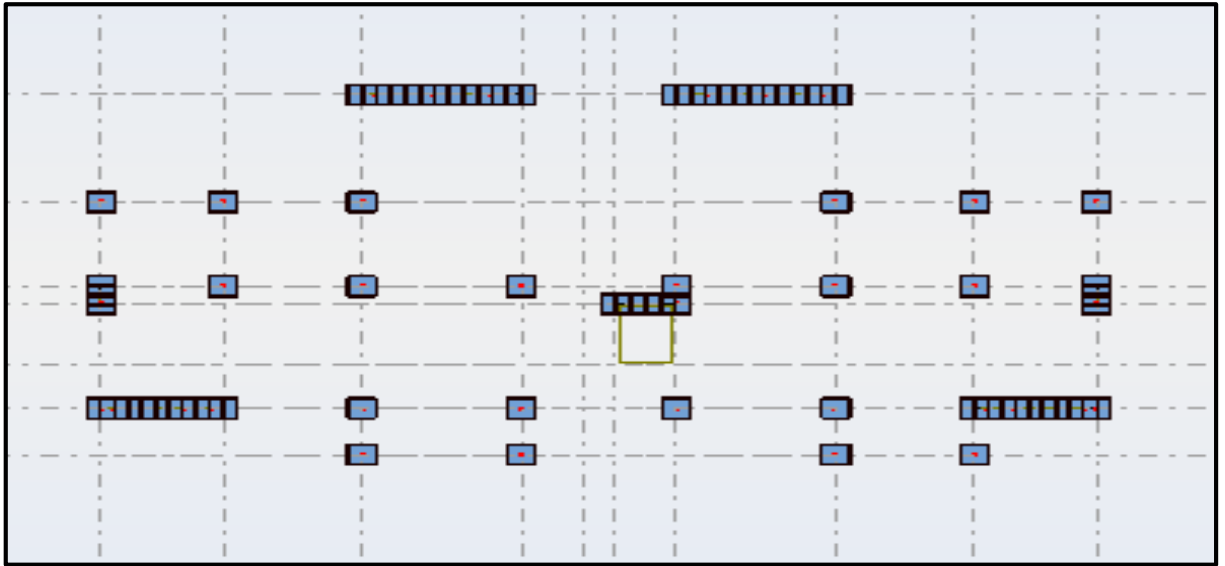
Vue en plan pour la disposition du voile selon le plan initial
